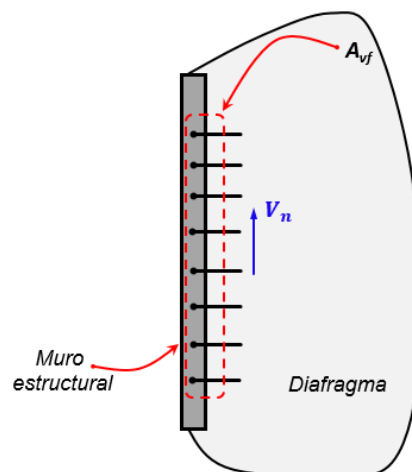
Representación esquemática del refuerzo  $A_{vf}$  en la interface losa - muro estructural
